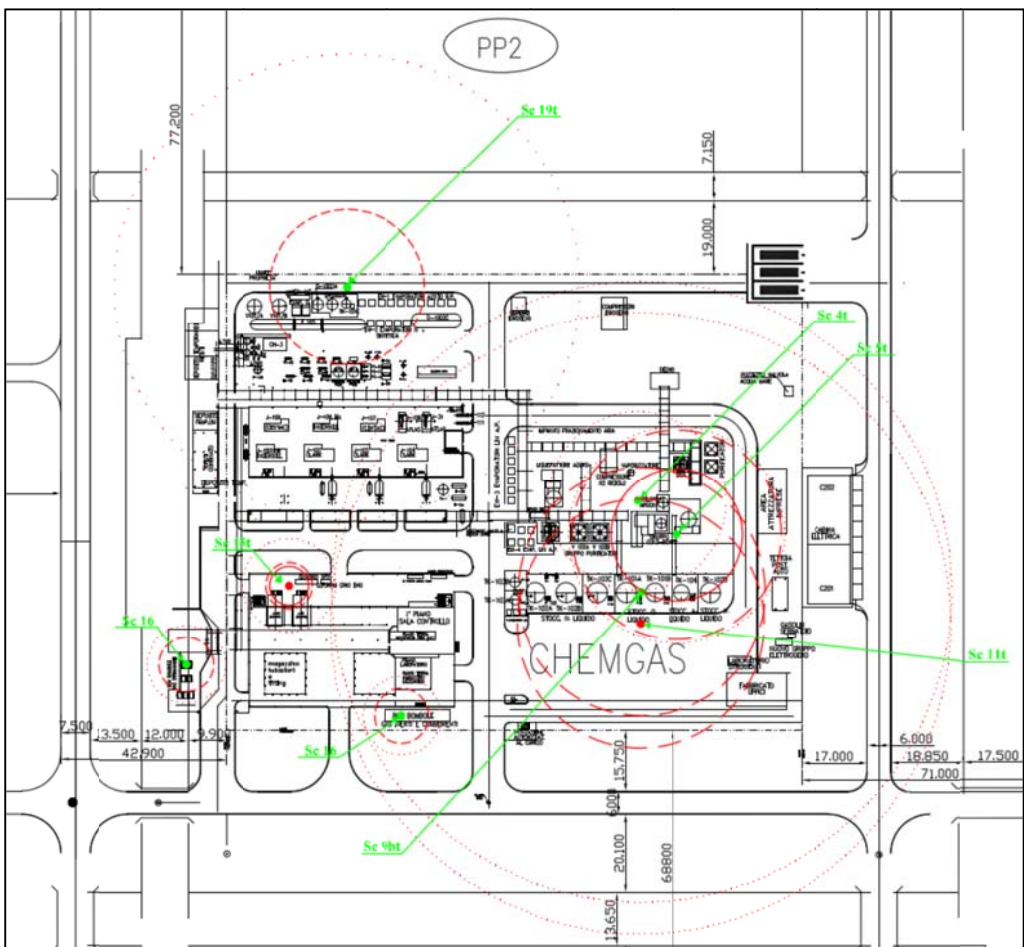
Stralcio della Planimetria limiti proprietà impianto – Dispersioni Ossigeno Rottura Totale F2
